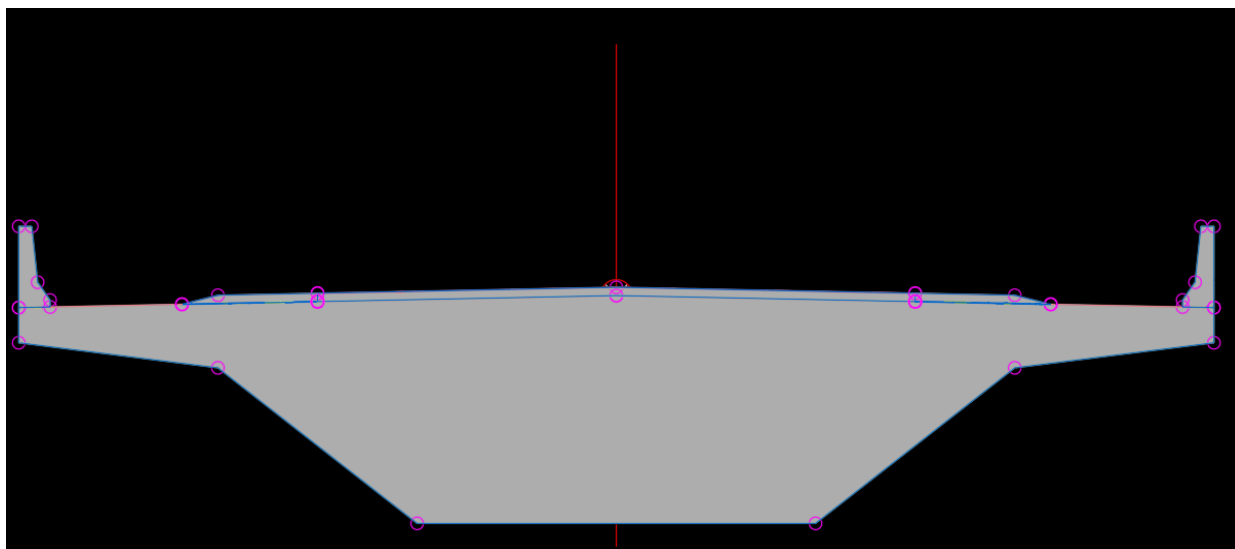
Ensamblaje Puente de Vigas1 con carril con bombeo y arcén en AutoCAD Civil 3D.
